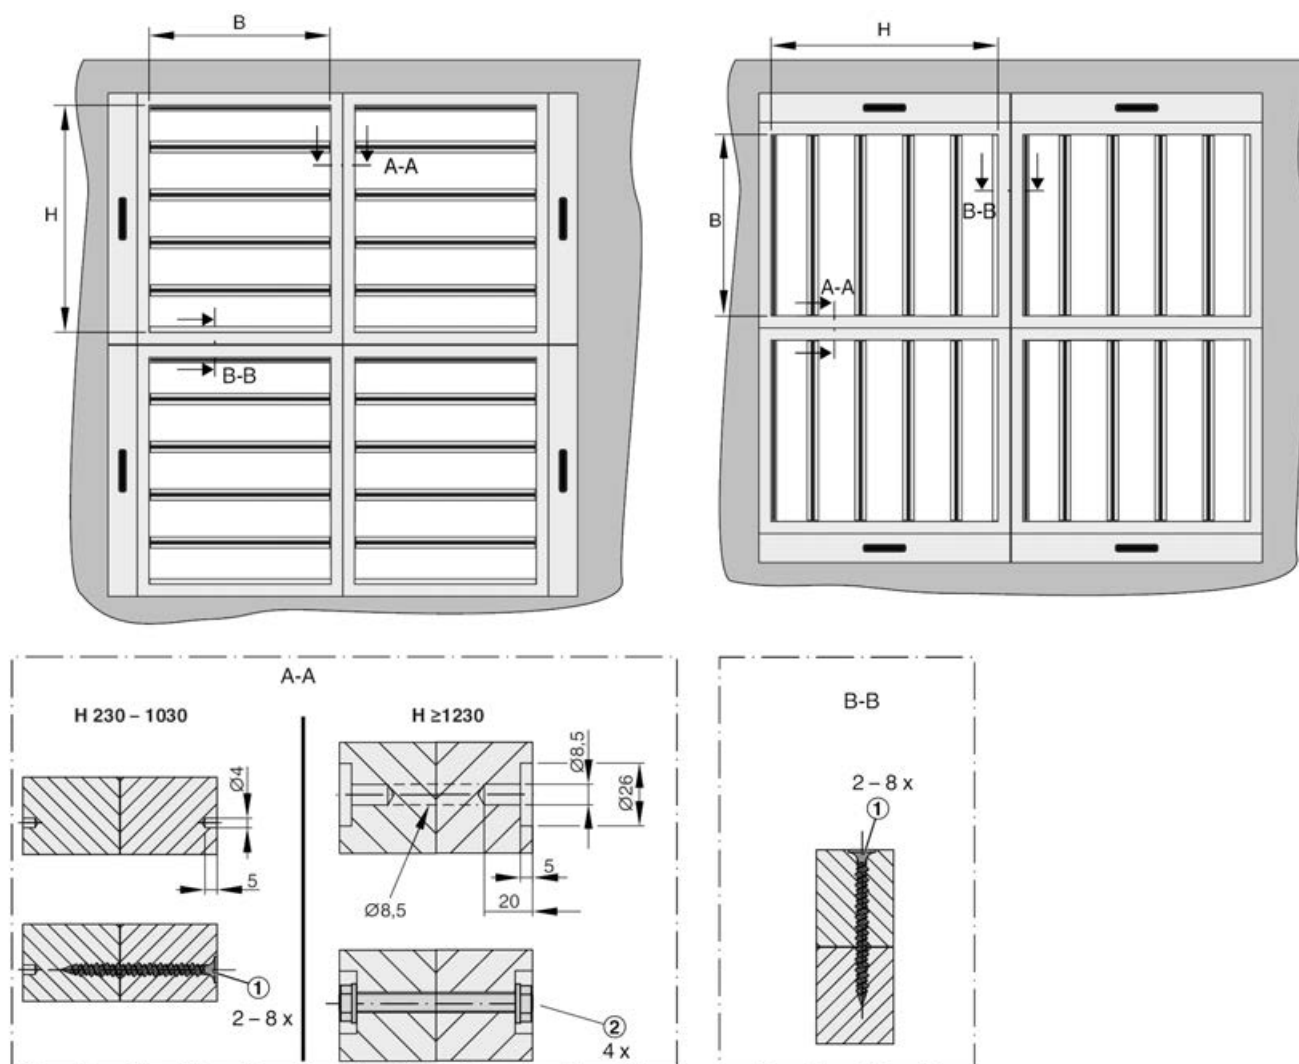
Posición de instalación de compuerta EK-JZ a otra compuerta, múltiple, horizontal y vertical
